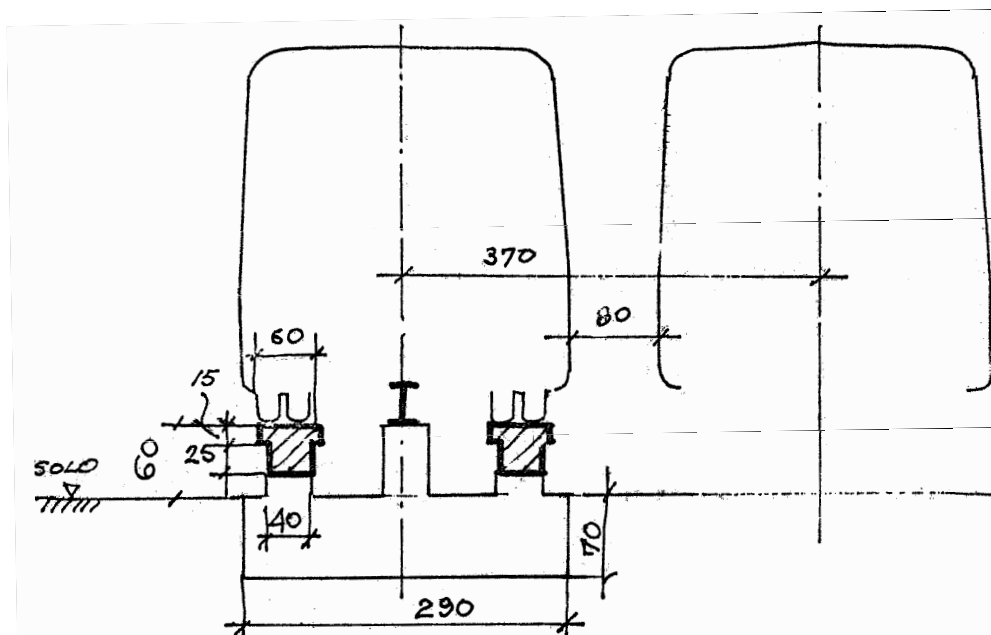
Plano Preliminar do Metrô - secção da via ao nível do solo
